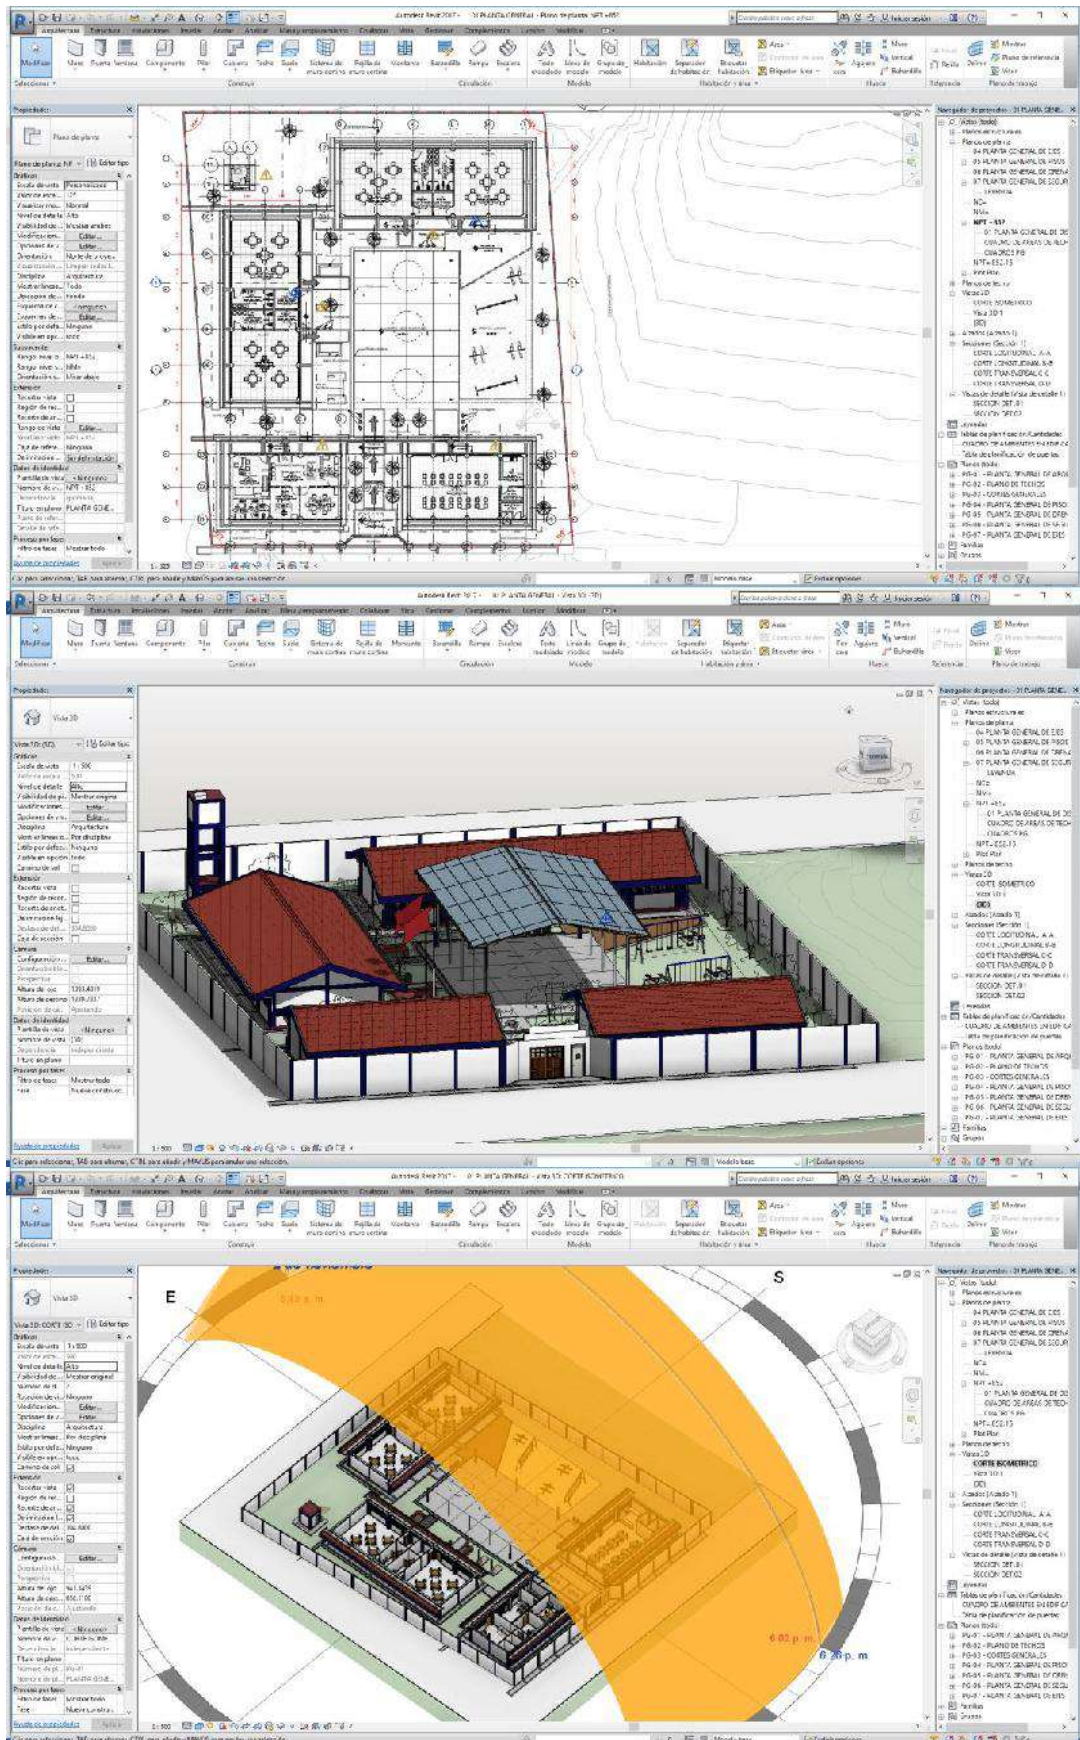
Modelamiento Planta General - Modelos vinculados
